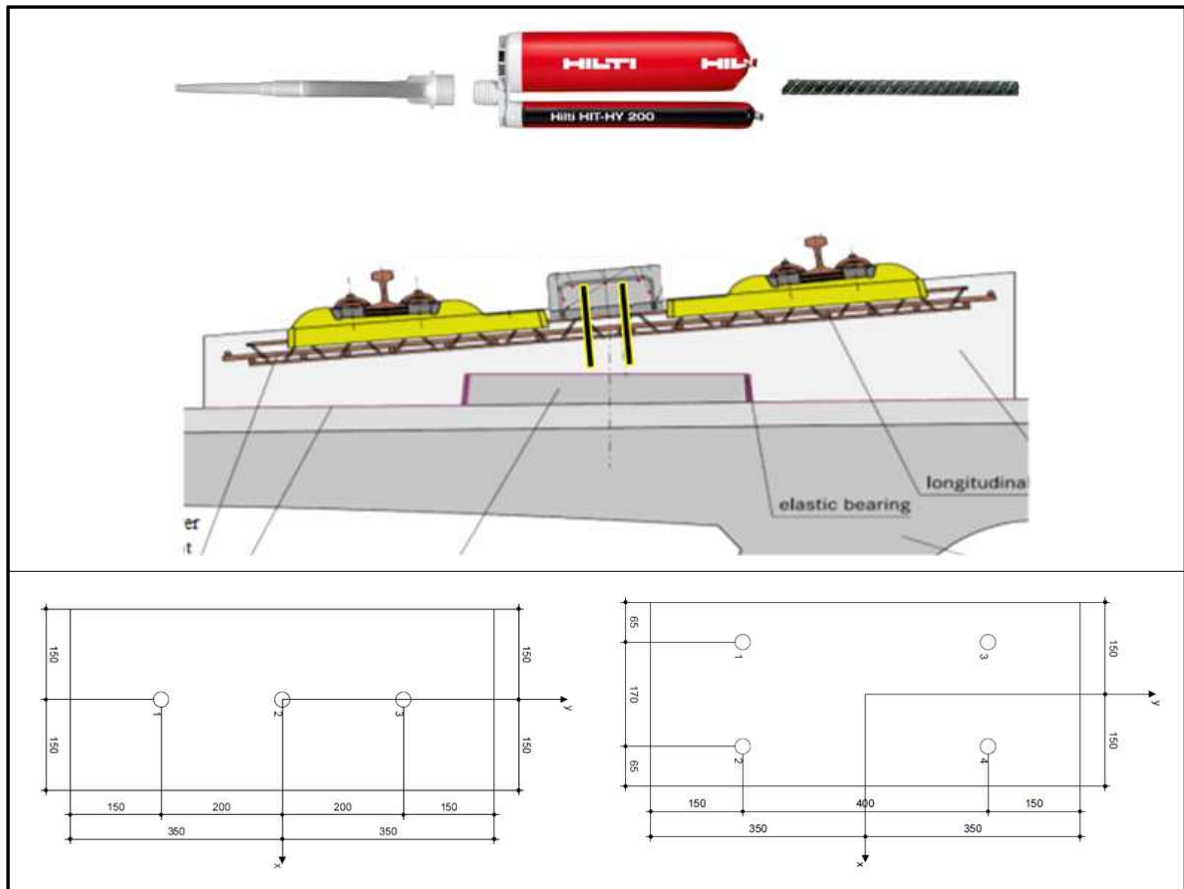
케미칼 앵커를 이용한 Precast Concrete Plinth 시공(안)
